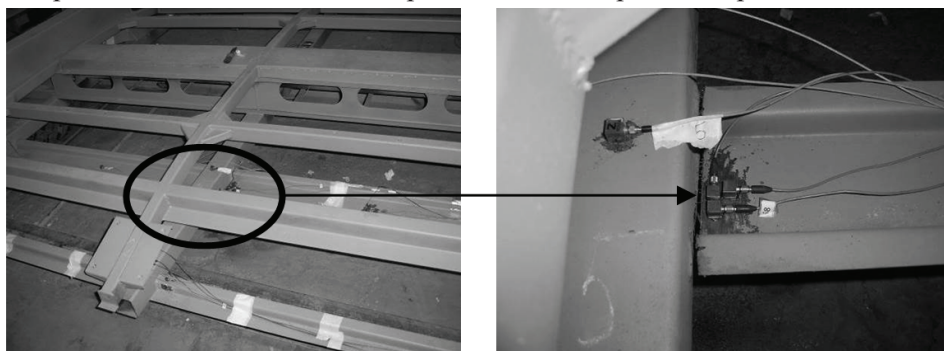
Каркас крыши с одним некачественным сварным швом
